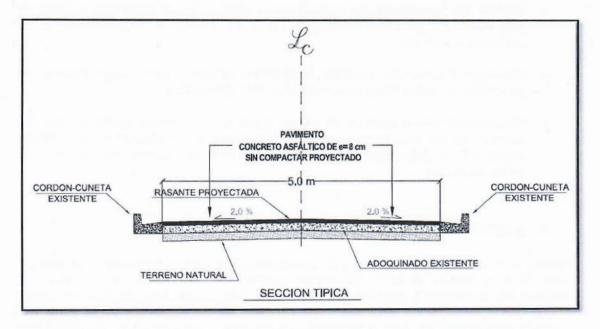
Detalle de la sección típica de la 2ª Calle Poniente y de la 1ª Avenida Norte-Sur.
